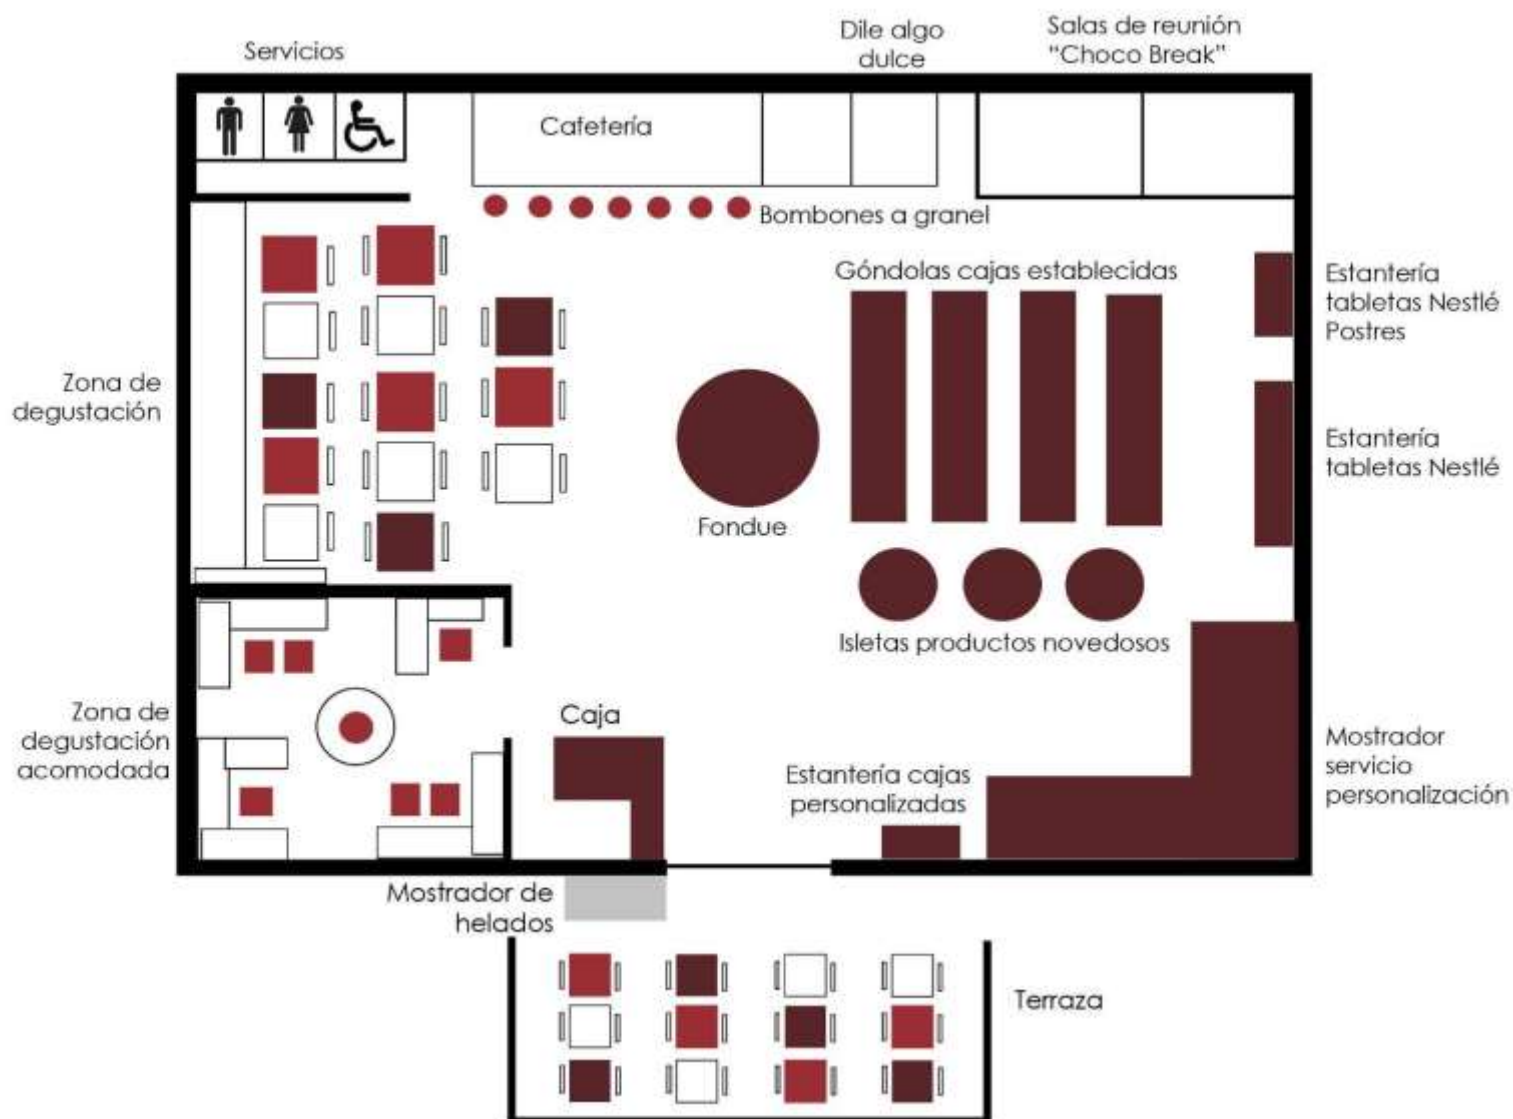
Plano de planta punto de venta *Díselo con Chocolate*. Elaboración propia.
